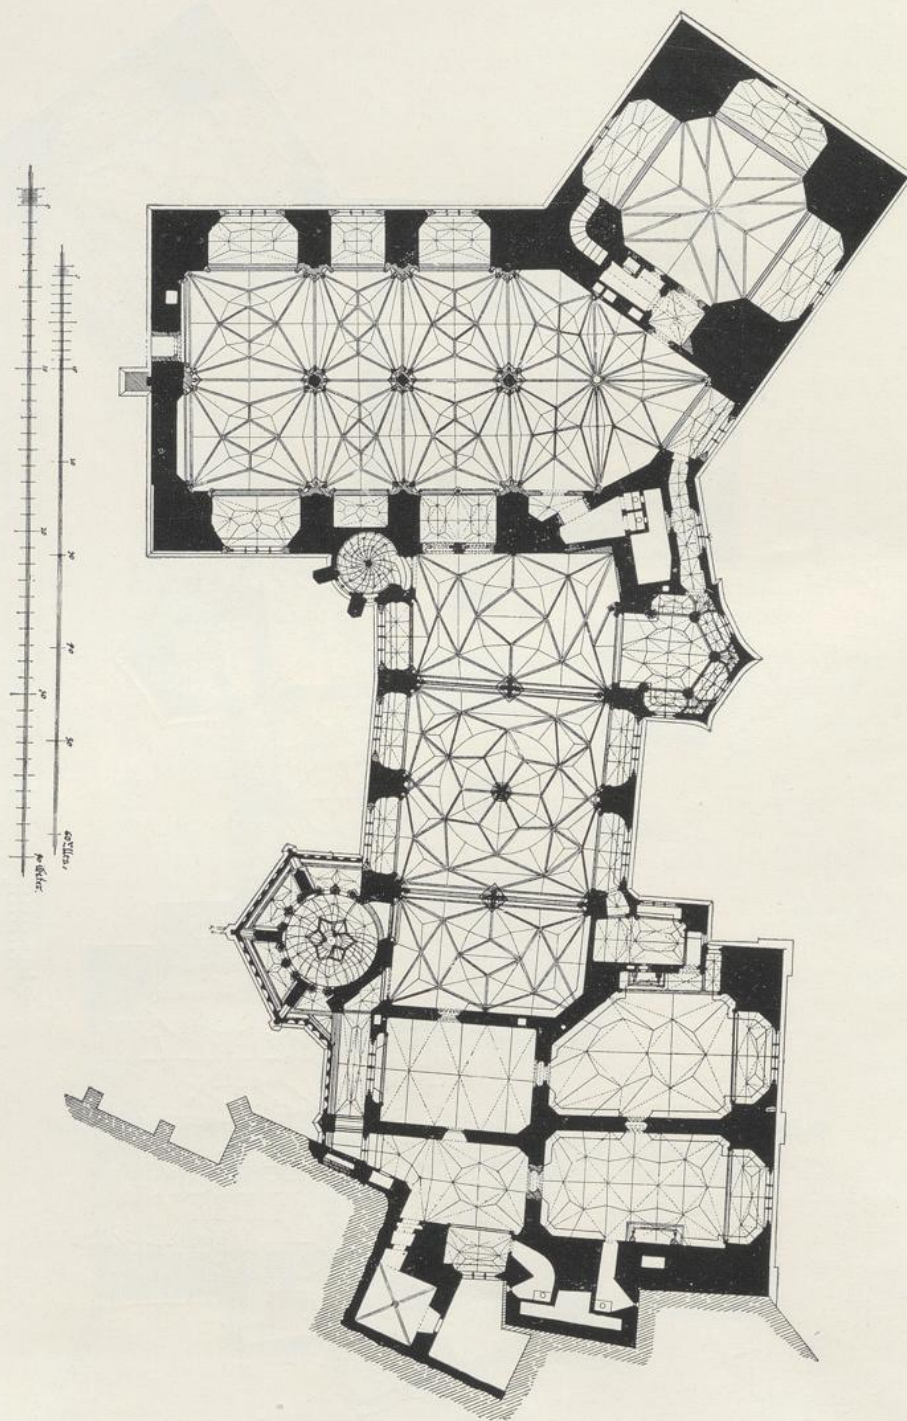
c. Albrechtsburg zu Meissen. Grundriß des zweiten Obergeschosses.
